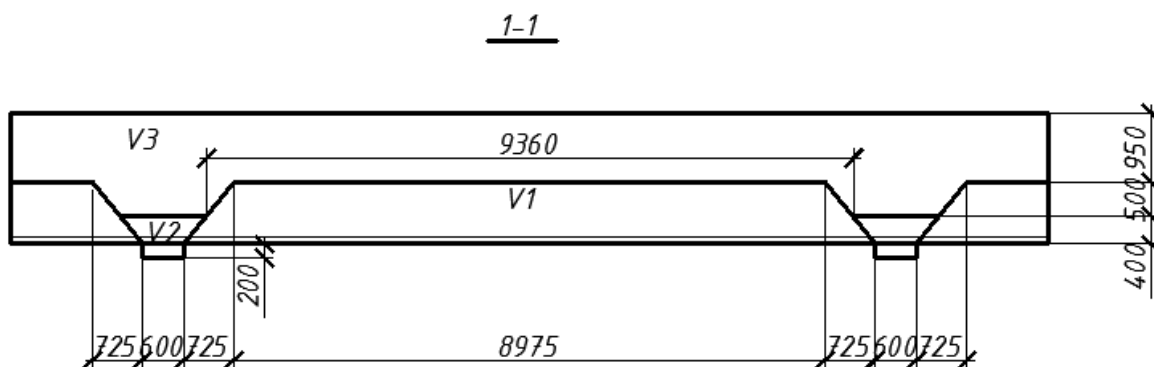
Разрез 1-1 схемы засыпки трубопровода
